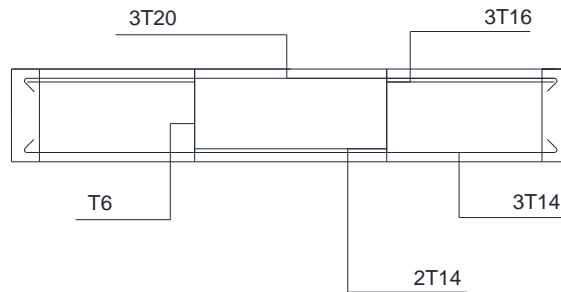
Coupe longitudinale d'une poutre principale 35x55cm (plan avec longues travées)
